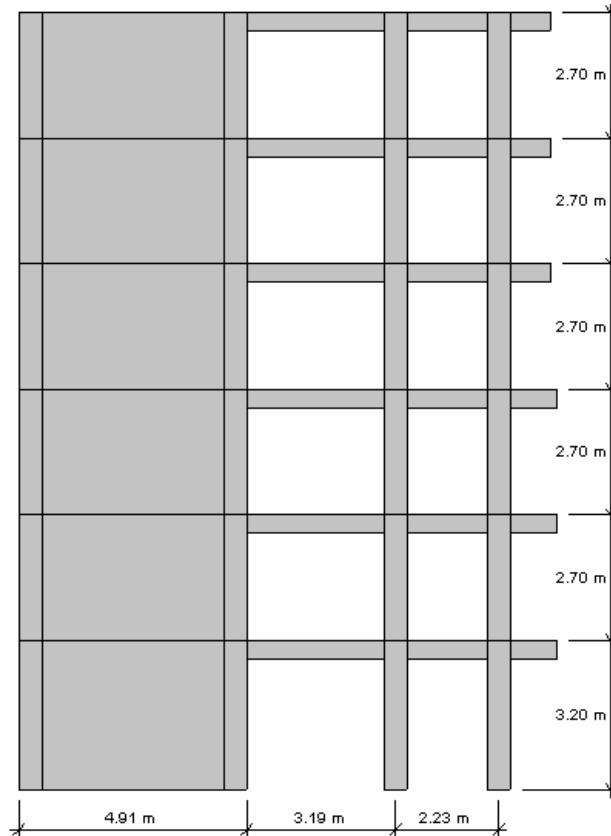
Elevación del sistema dual de concreto armado a diseñar
